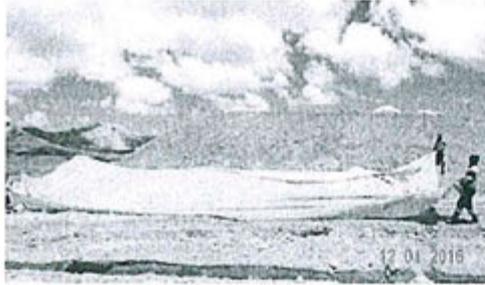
Traslado de manta plástica hacia el lado norte del Depósito de Stock Pile Top Soil.
